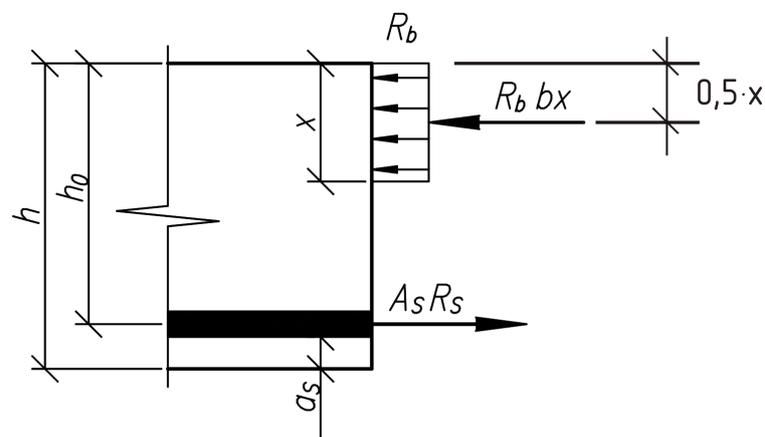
Схема внутренних усилий и эпюра напряжений в поперечном сечении изгибаемого железобетонного элемента таврового профиля (с одиночной арматурой) с полкой в сжатой зоне
